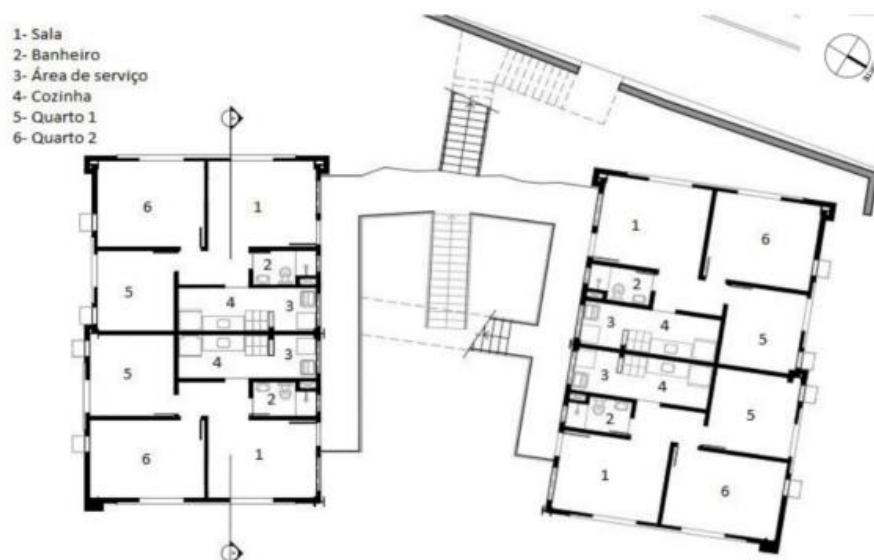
Planta baixa do primeiro pavimento (Fernandes, 2015)
